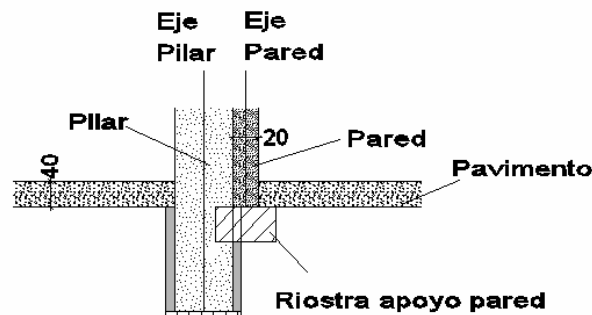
Detalle sujeción panel con el pavimento de la nave
